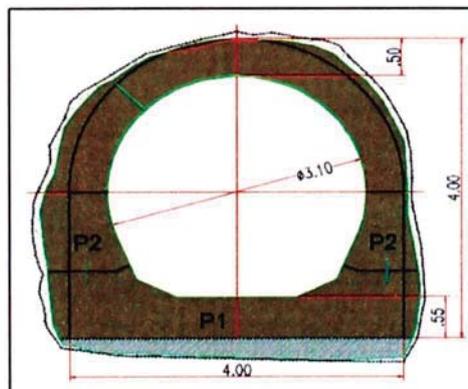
Sección Tipo II - Revestimiento de Concreto ($e=0.5 \text{ m}$)
